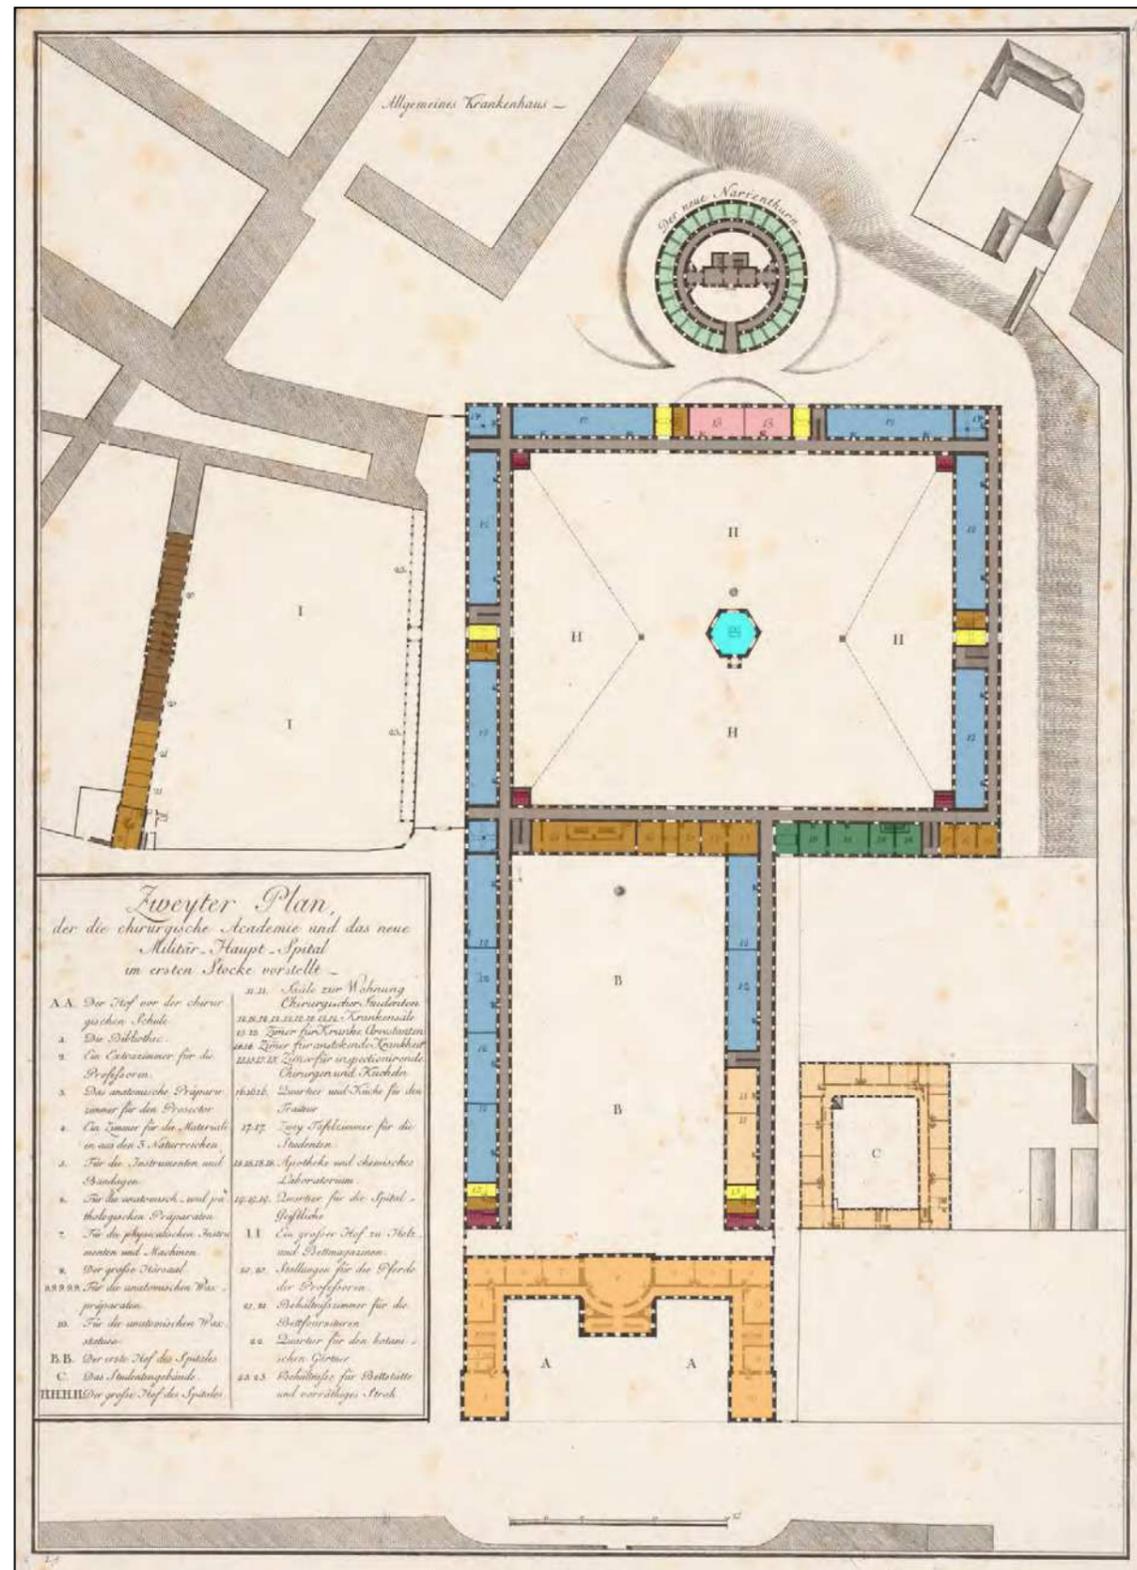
Das Josephinum und das Militärspital, erstes Obergeschoss, Grundriss von Josef Gerl, 1784.
